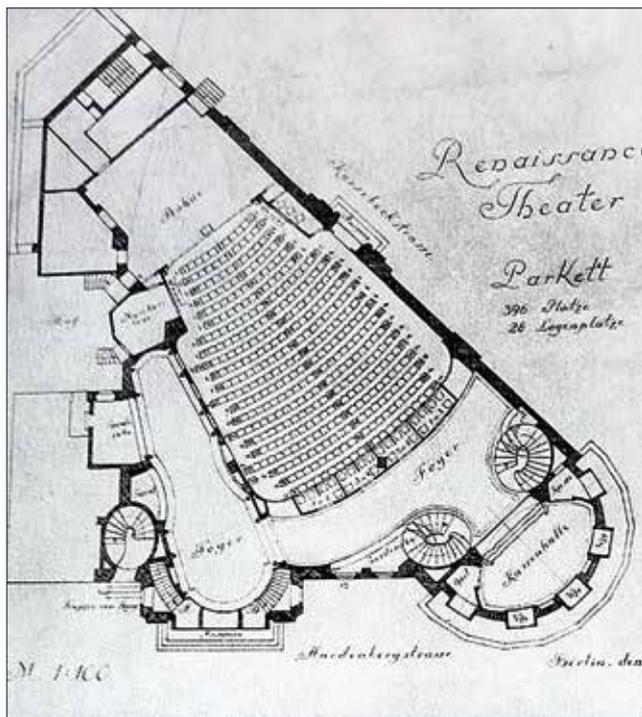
Grundriss Erdgeschoss, 1927
